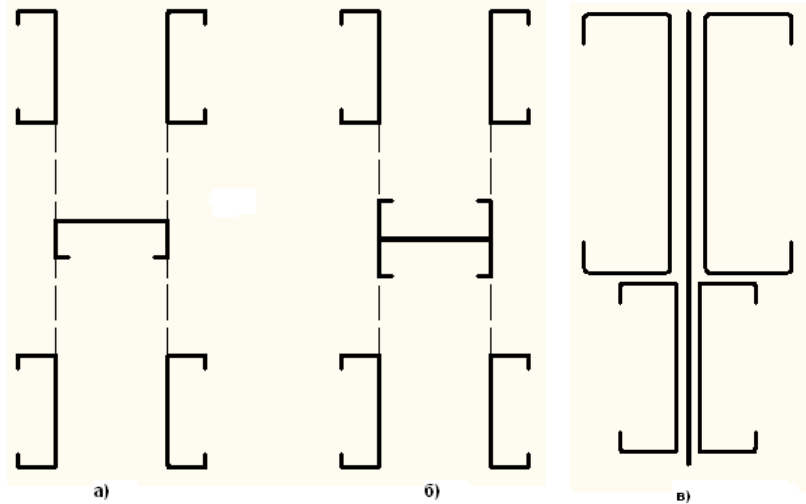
Конструкция поясов и решетки ферм из ЛСТП: а) Ферма, пояса которой состоят из двух спаренных С-профилей, решетка – одиночный С-профиль; б) Пояса и решетка фермы выполнены из спаренных С-профилей; в) Ферма на фасонках, пояса и решетка выполнены из спаренных С-профилей
